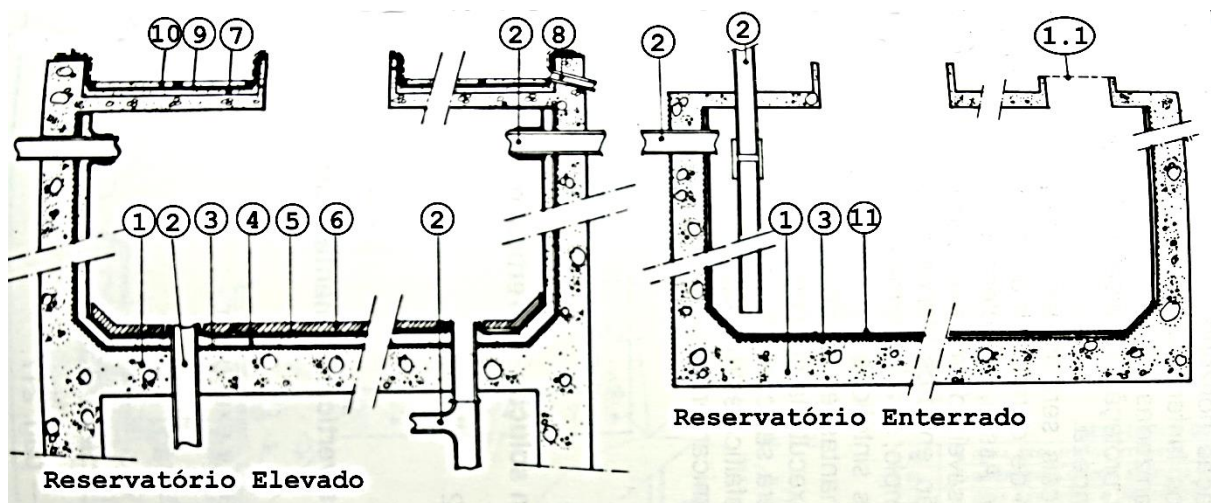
Impermeabilização interna de reservatórios. 1) estrutura: laje em concreto armado; 1.1) em reservatórios grandes, abertura complementar para ventilação do ambiente, pode ser fechada posteriormente; 2) instalações de condutores hidráulicos; 3) apicoamento energético geral; 4) preparação da superfície com argamassa rígida; 5) impermeabilização flexível ou semi-plástica; 6) proteção mecânica contra erosão e ferimento em cimento e areia no traço 1:3, espessura de 4 cm só no piso e meia cana; 7) cobertura: argamassa de regularização cimento e areia 1:3; 8) sistema coletor de águas pluviais 3" de diâmetro; 9) impermeabilização; 10) proteção mecânica contra ferimentos e 11) impermeabilização com argamassa rígida (Fonte: PIRONDI, 1988).
